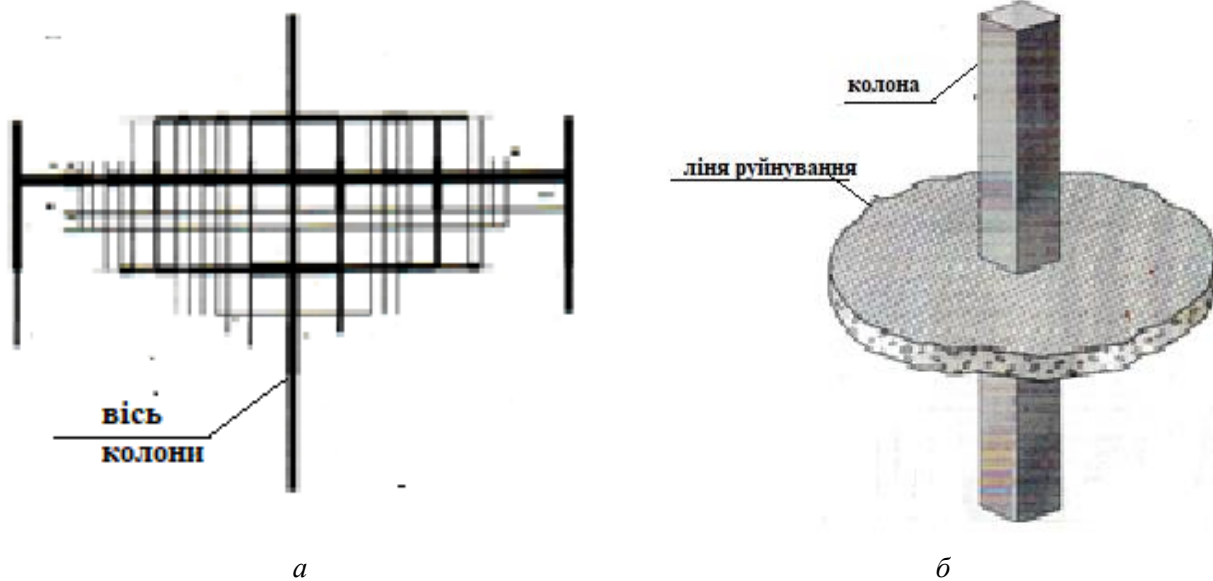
Механізм руйнування залізобетонних монолітних безбалкових плит перекриттів каркасно монолітних будівель від вибухових впливів:
